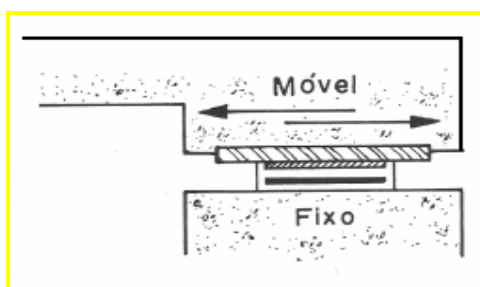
Aparelho de apoio deslizante entre a parede e a cobertura
